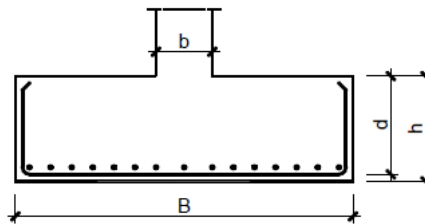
Esquema das dimensões geométricas da sapata (fonte: Apontamentos de Fundações e Estruturas de Suporte, António Arêde).
